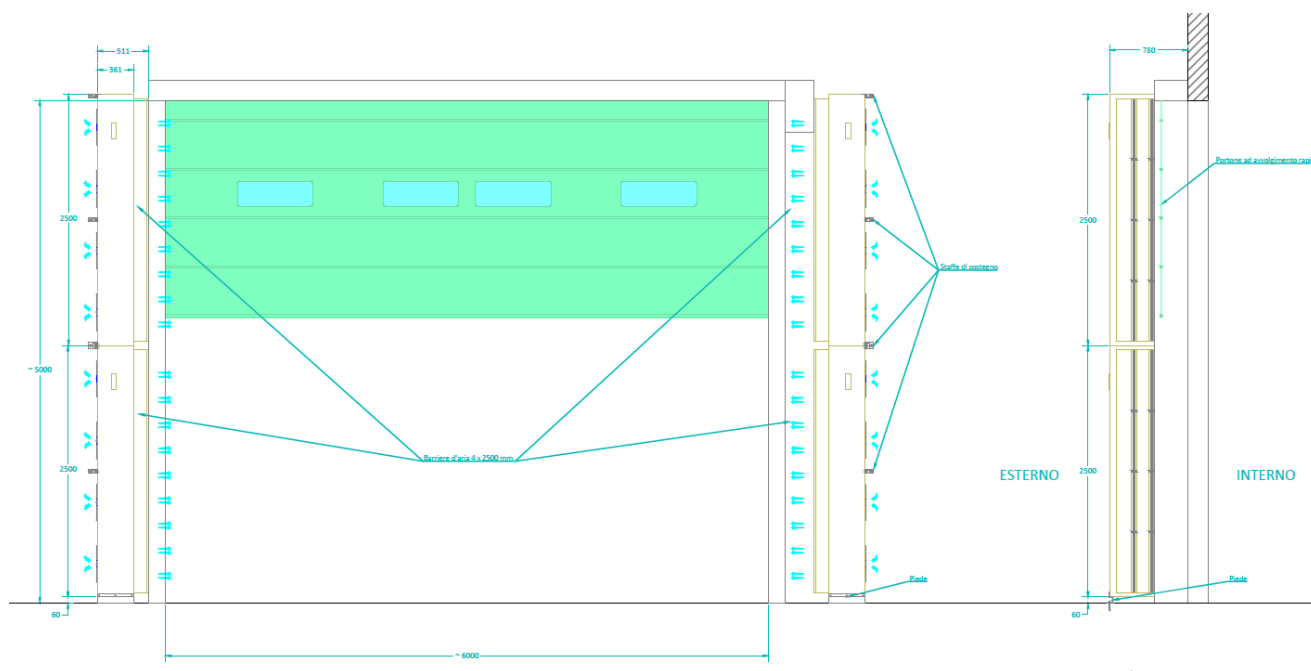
Schema tipo di sistema a barriera d'aria con portone ad impacchettamento rapido in fase di apertura.
